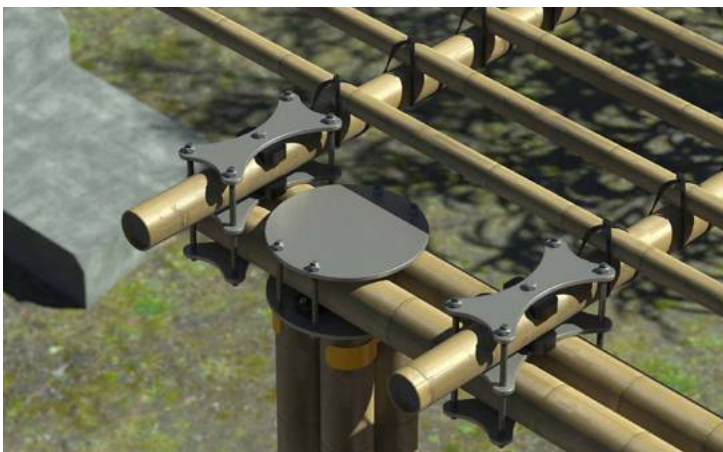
Detalle vínculo superior de unión entre la columna y vigas principales.
